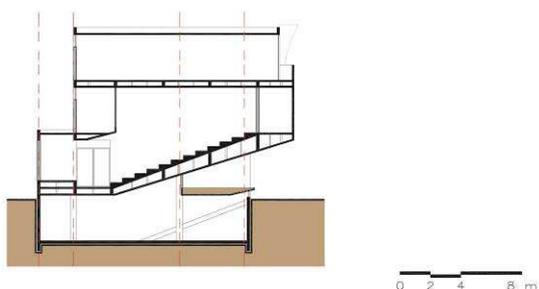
Corte transversal. Fonte: Redesenho elaborado pela autora com base em projeto legal da prefeitura, 2014.
